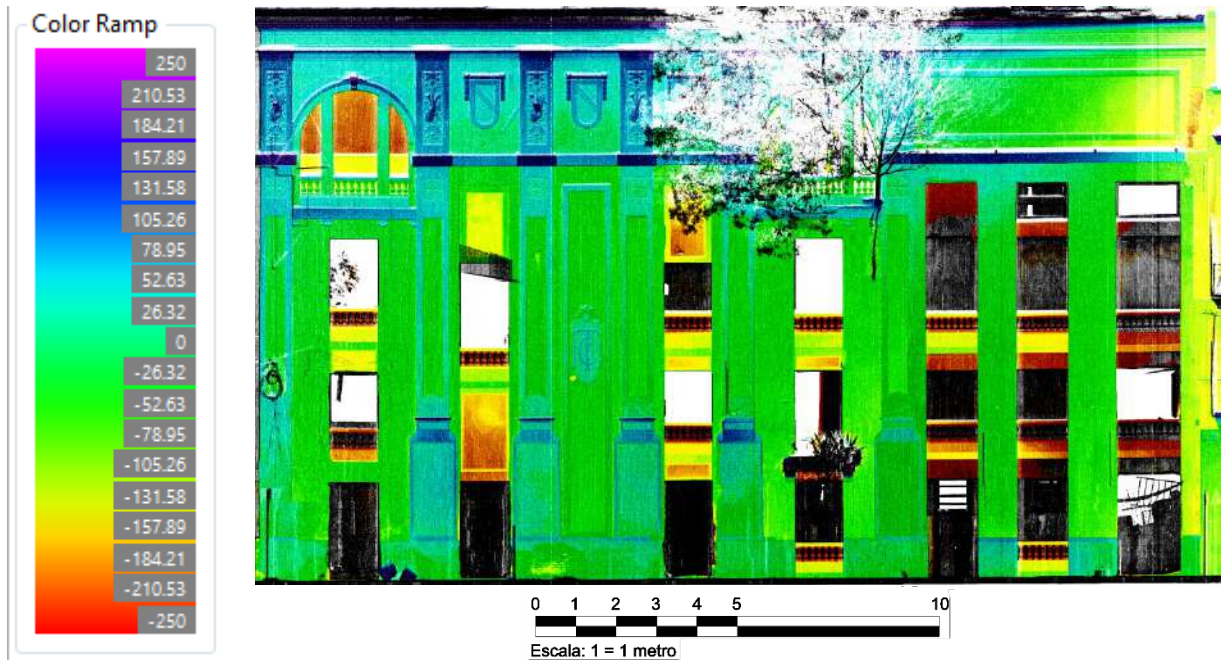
Modelo de elevación de la fachada hacia la calle San José.
